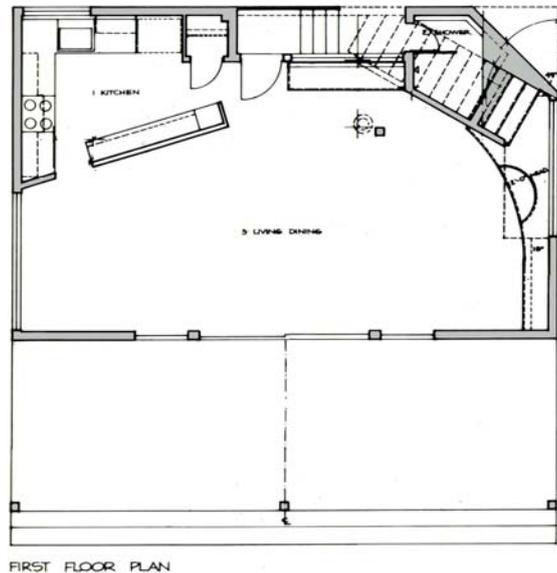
Planta baixa. Primeiro pavimento.
